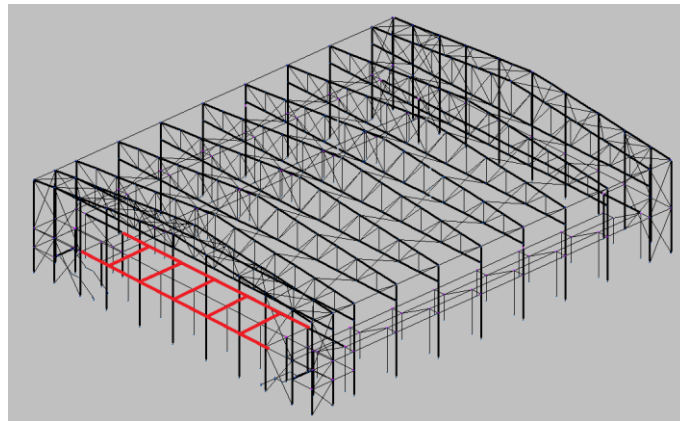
Vigas de la zona puente con aseos de la segunda planta.
